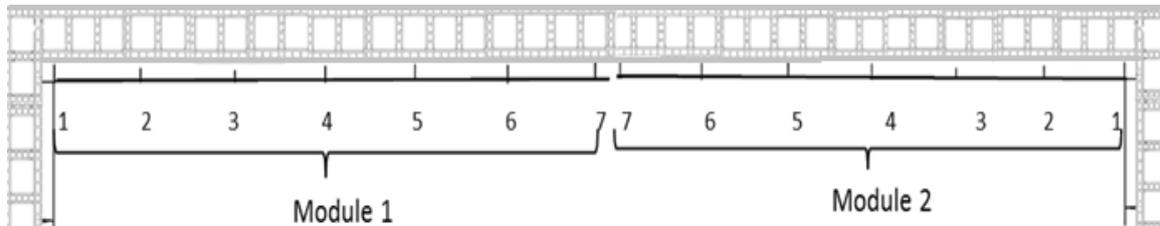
Exemple de traitement des joints (coupe horizontale)
